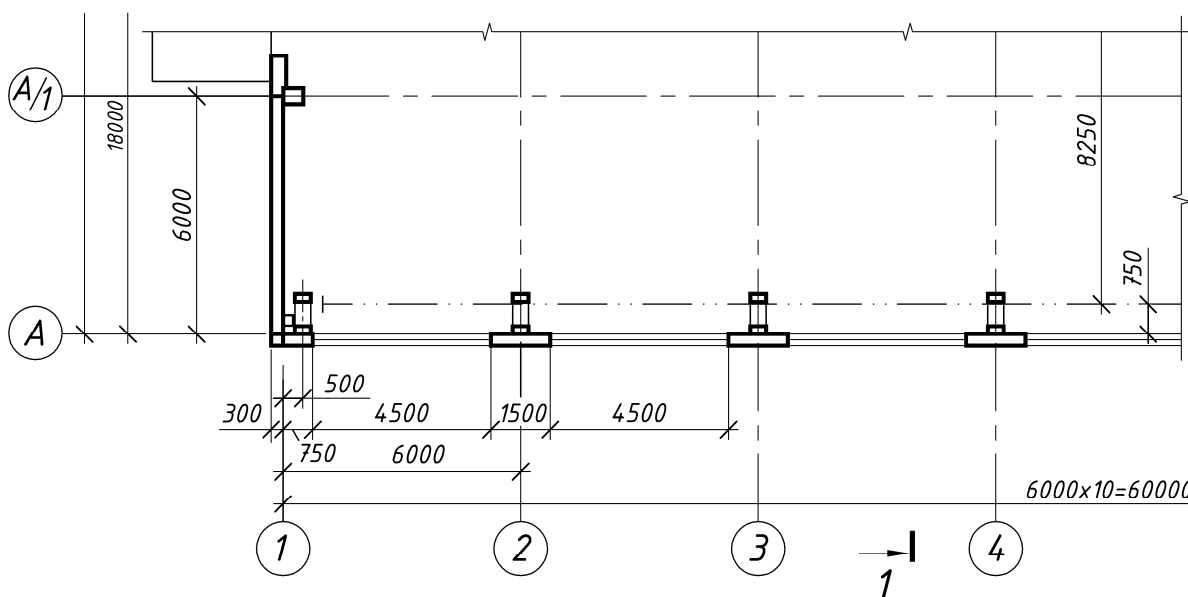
Нанесение размеров на фрагменте плана здания
